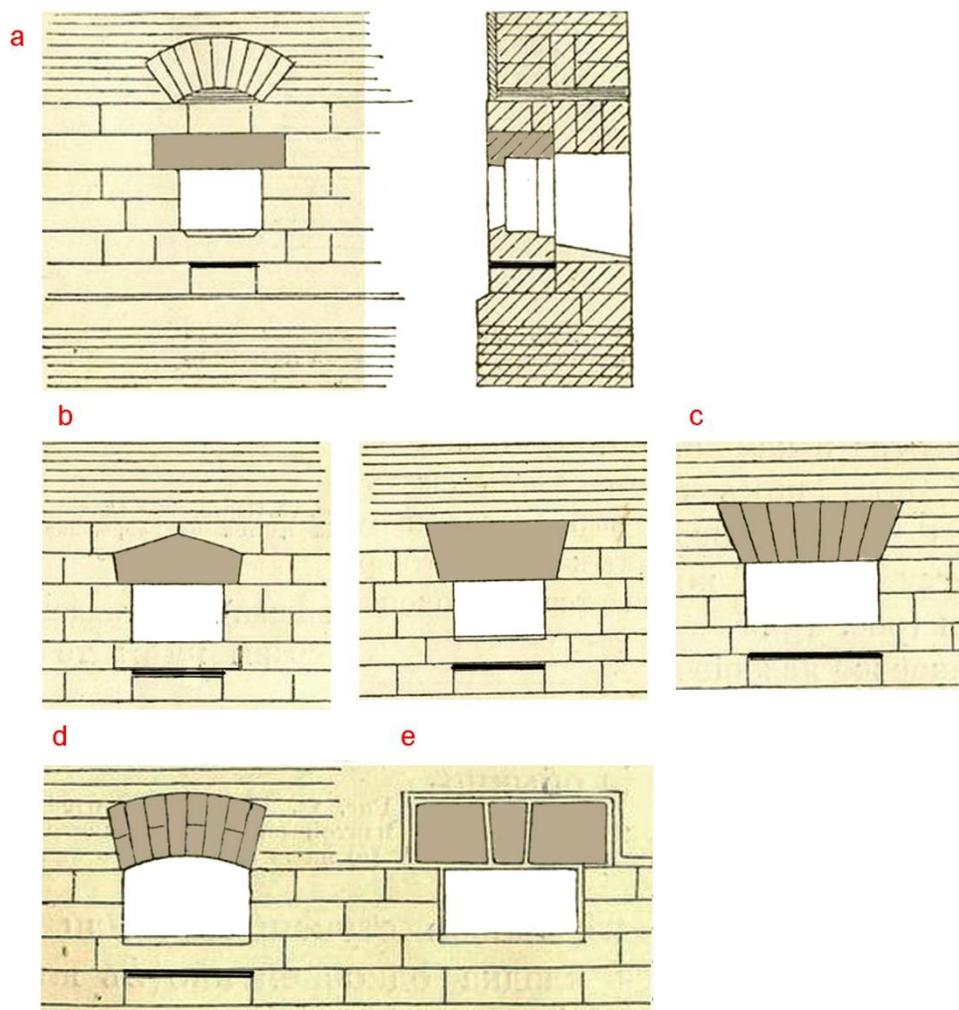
Оконные проемы в кордонной кладке цоколя (закладной цоколь): а – перекрытие проема плитой с устройством разгрузочной арки и прозором под подоконной плитой (фрагмент фасада и разрез); б – перекрытие плитой на ребро с наклонным боковым швом; с – перекрытие перемычками из плит; д – перекрытие кирпичной арочной перемычкой; е – перекрытие кирпичной перемычкой с последующим оштукатуриванием и покраской [32]
